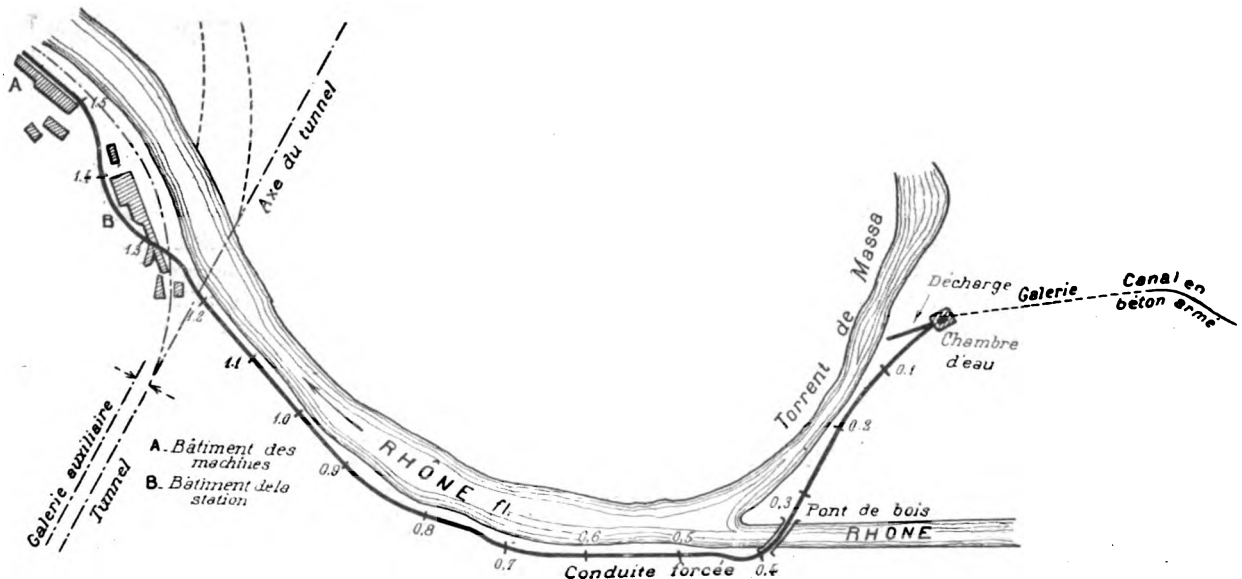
Travaux du Simplon. Plan général des installations hydrauliques.
